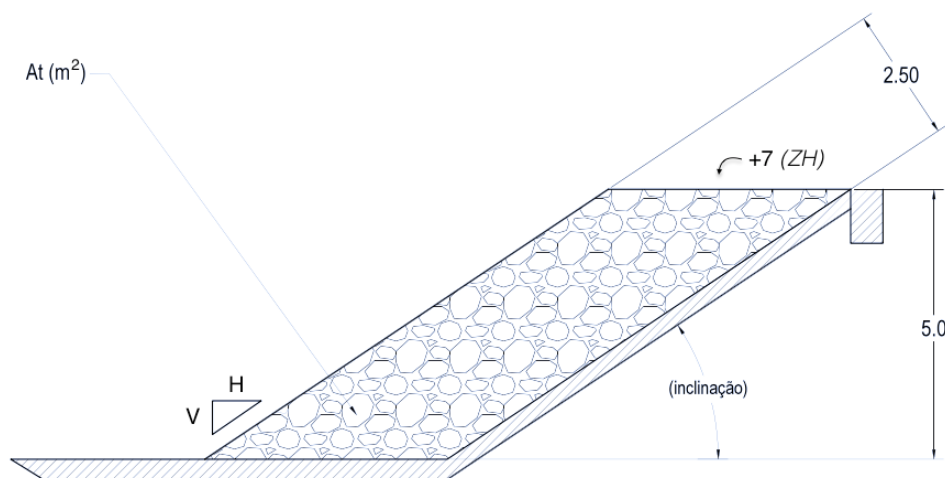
Perfil tipo de obra longitudinal aderente
